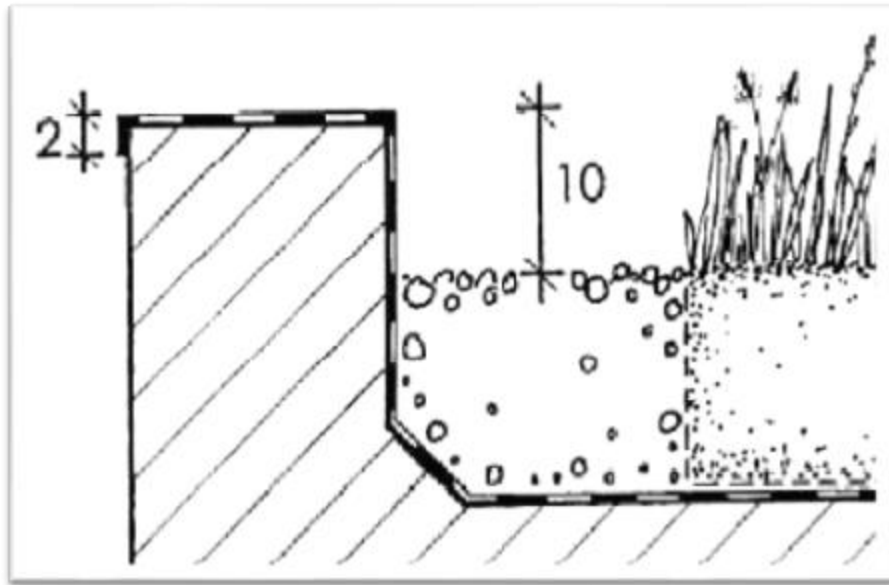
Terminación de azotea ajardinada con pretil, material de aislamiento y drenaje perimetral (Minke, 2005).
